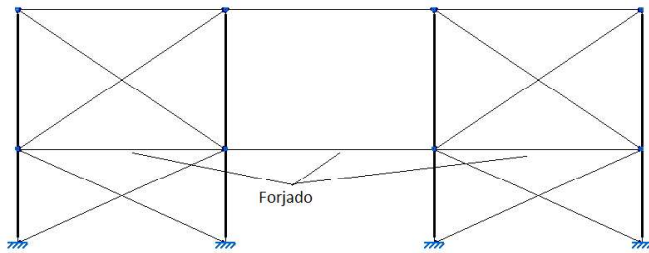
Arriostramiento de fachada lateral de la nave secundaria
